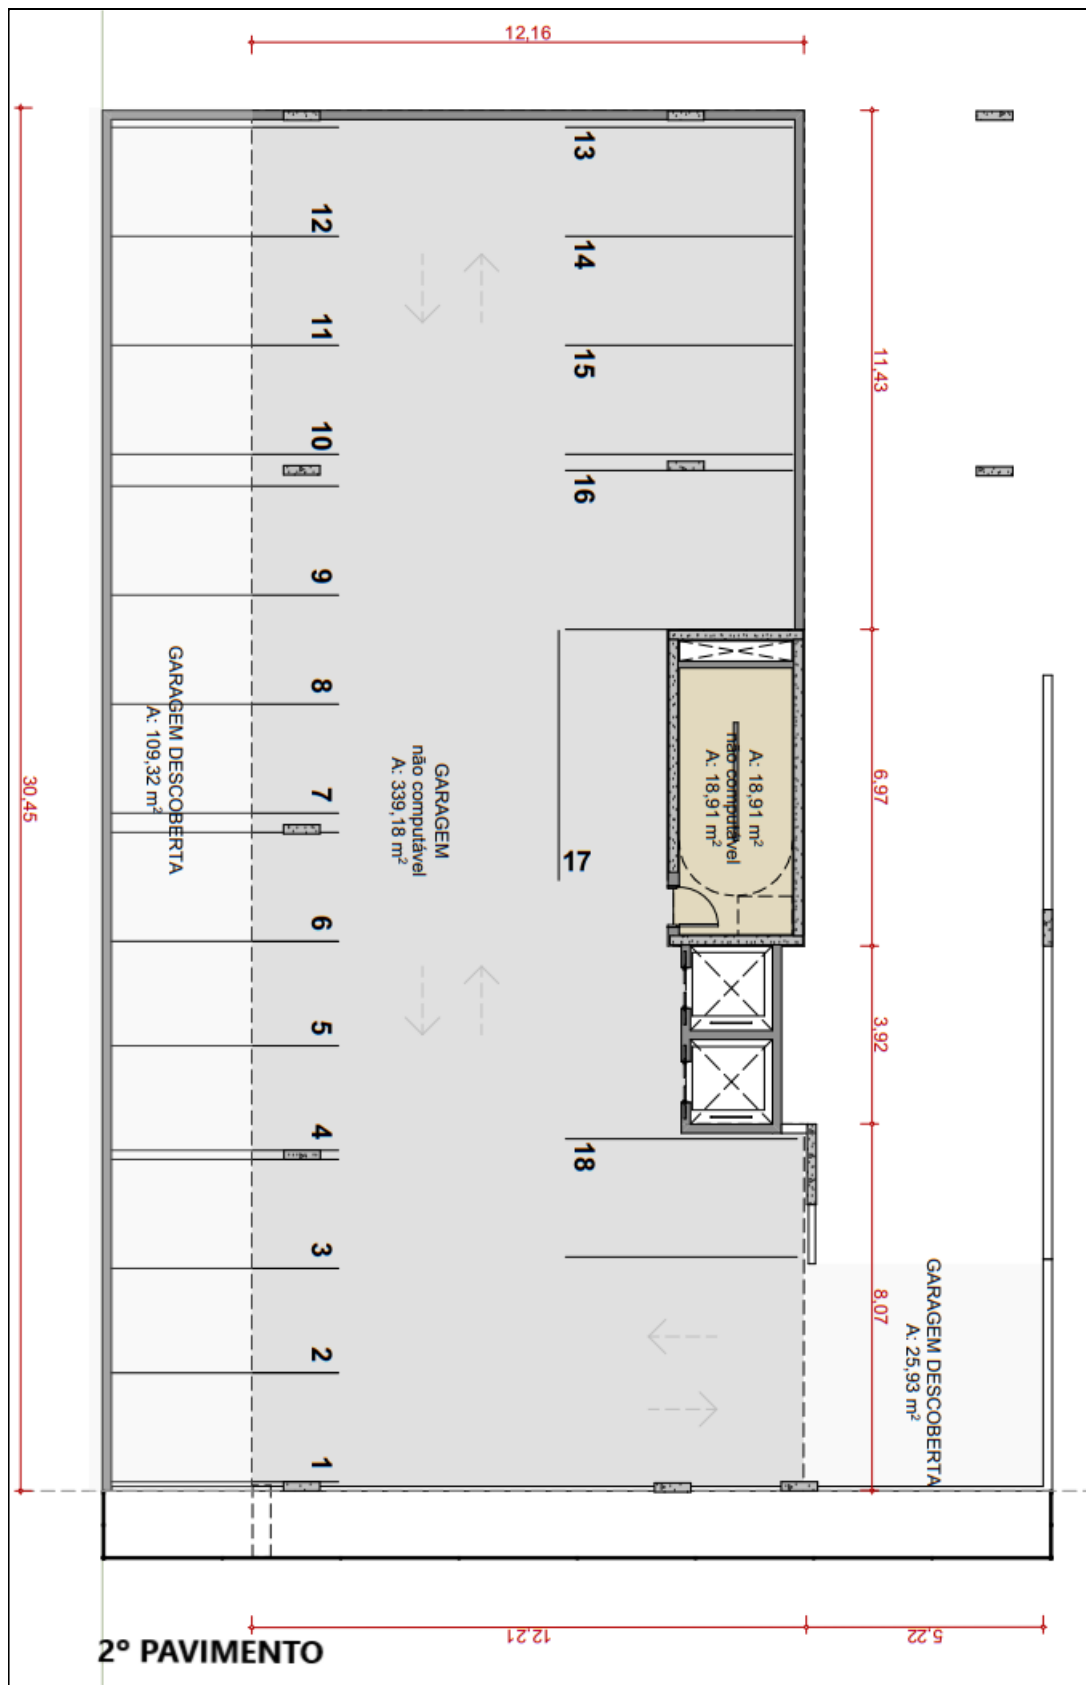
Planta do 2º Pavimento do Condomínio Sintropia Sky Garden.
